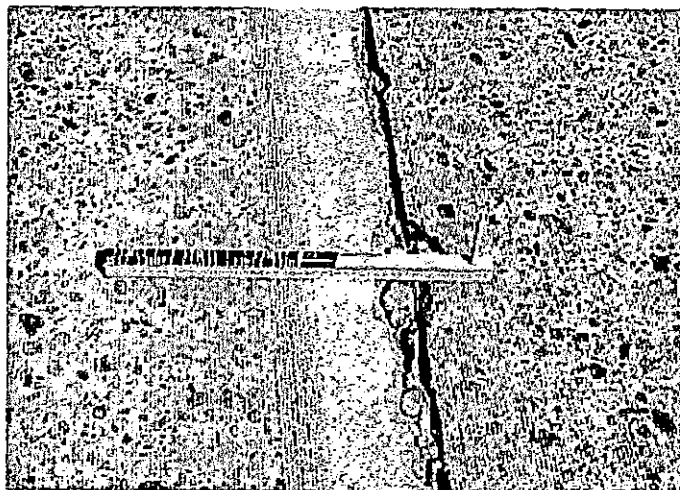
Desportillamiento de las juntas longitudinales con severidad Baja.
